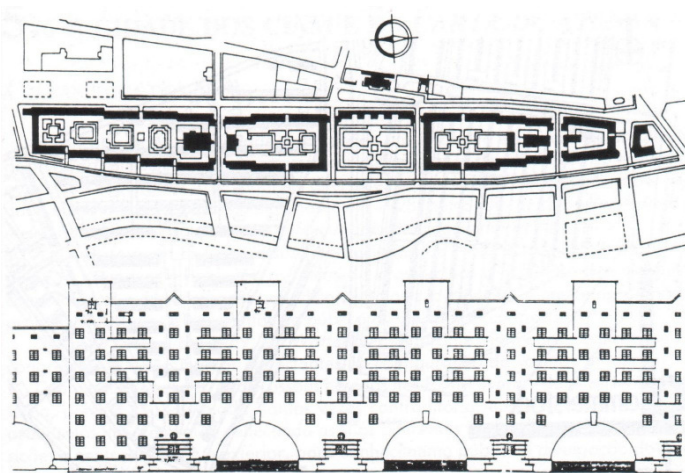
Viena: planta e vista do conjunto Harl Marx Hoff. Fonte: Lamas (1992, p.335)
